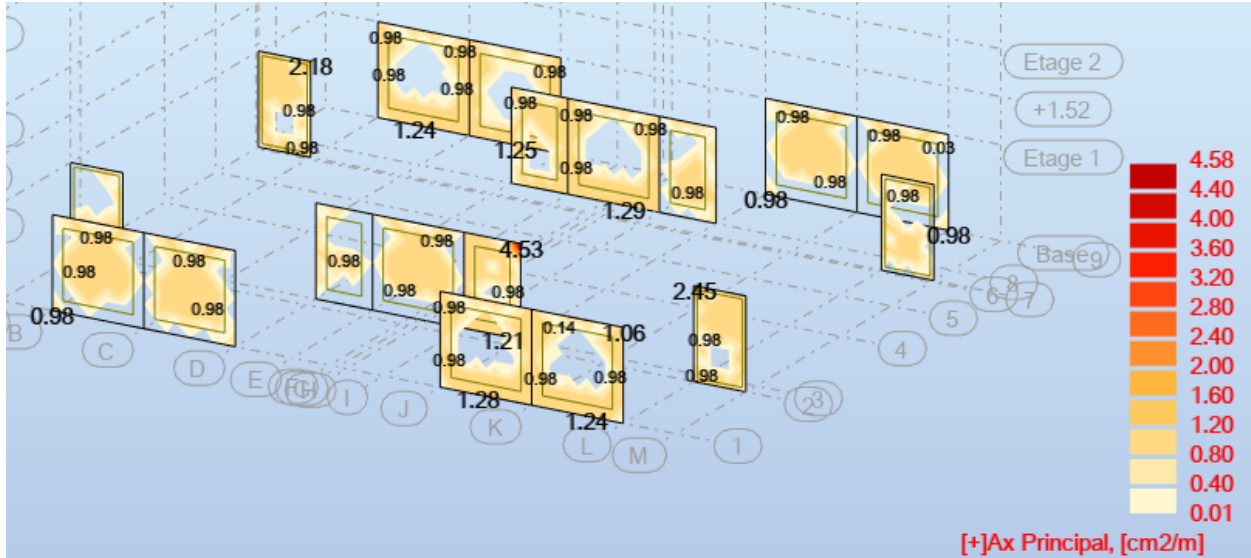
Armatures de la section supérieure sur le sens x-x.
